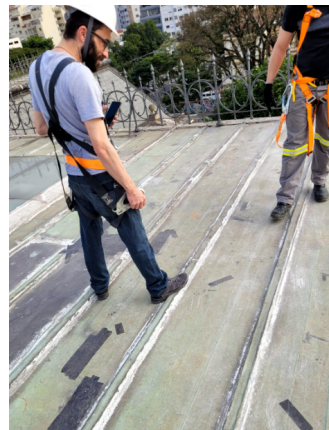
Isolamento emergencial da cobertura, devido aos pontos de infiltração, localizado nas salas de máquina dos elevadores.
